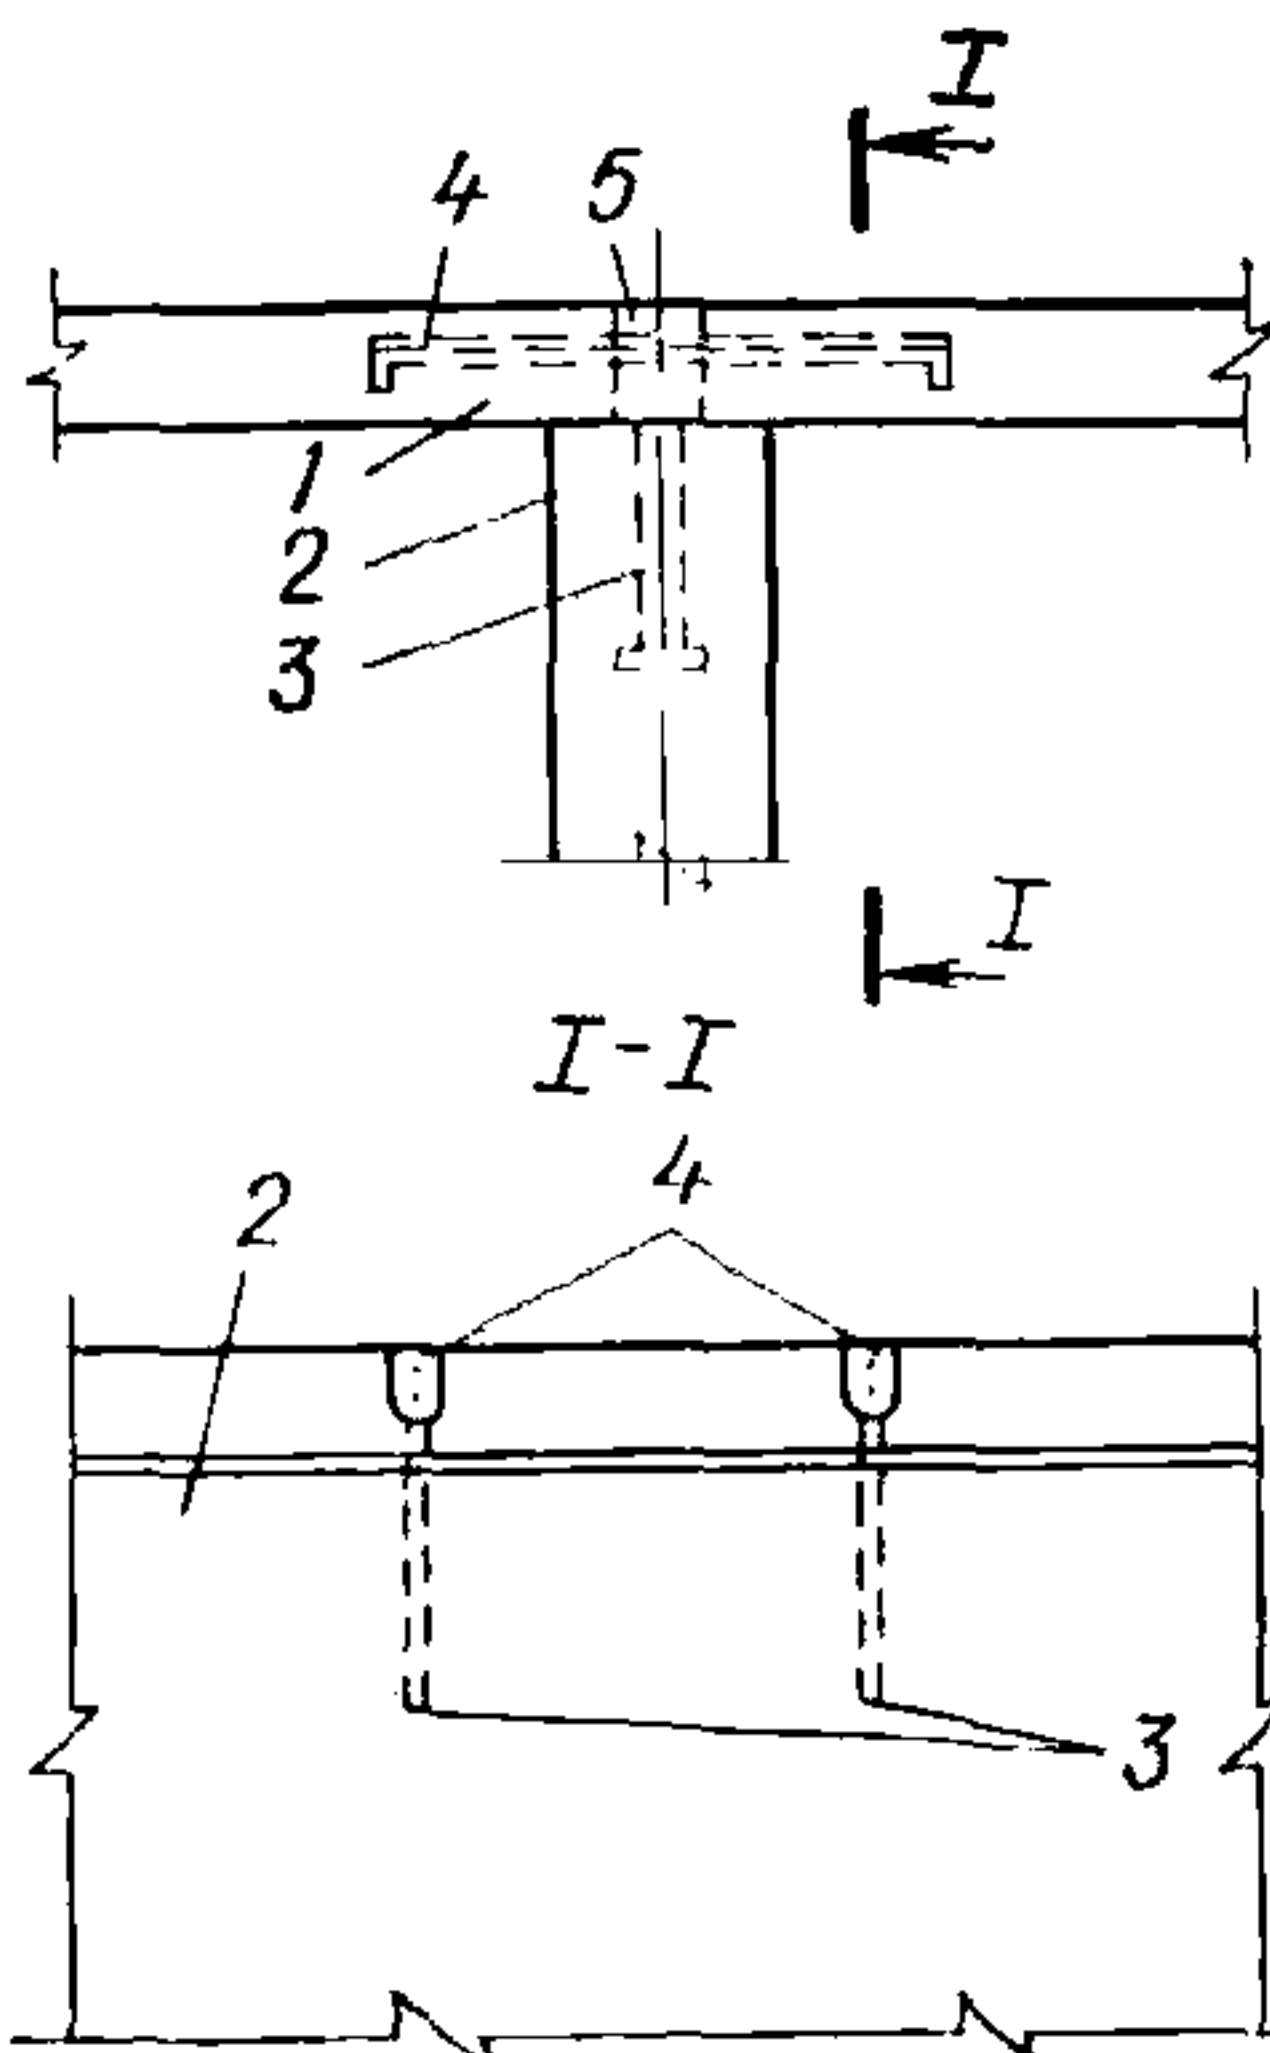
Соединение сборных железобетонных элементов стен и перекрытий с помощью сварки
